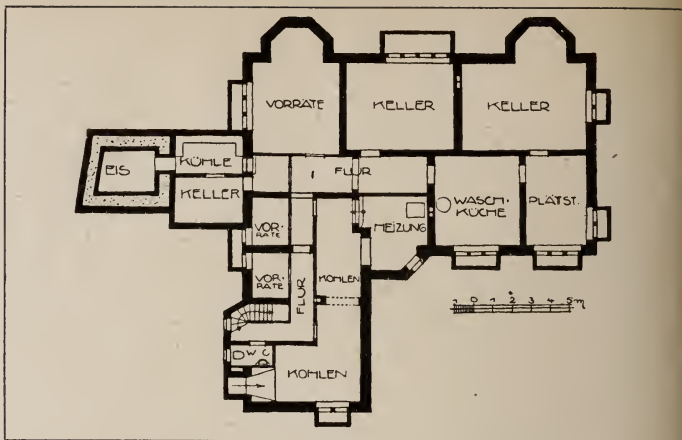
Kellergeschoß mit anschließendem Kühlkeller und Eishaus außerhalb des Hausgrundrisses
